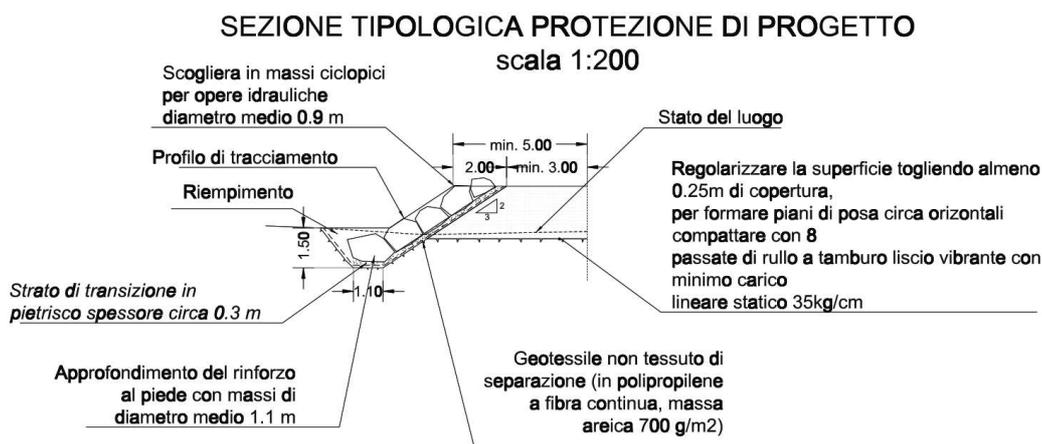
Sezione tipologica della nuova barriera di protezione tra le sezioni 16 e 20 (Elaborato IB0U1BEZZW9ID0000303C).
